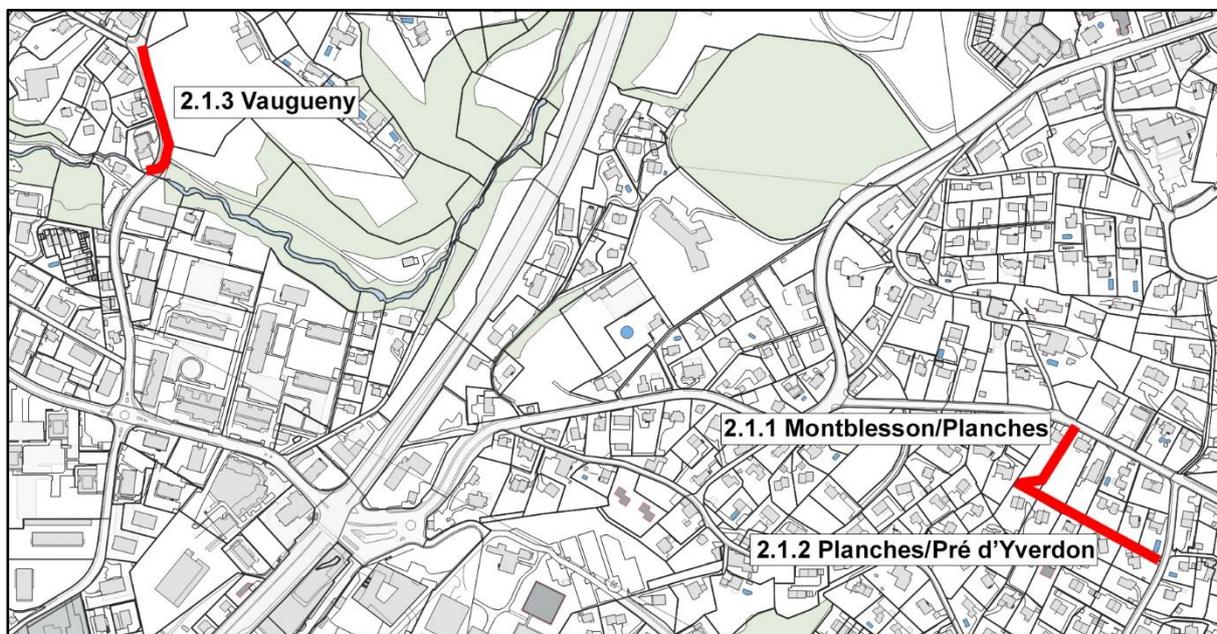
Plan de situation avec les chantiers faisant l'objet du présent préavis
